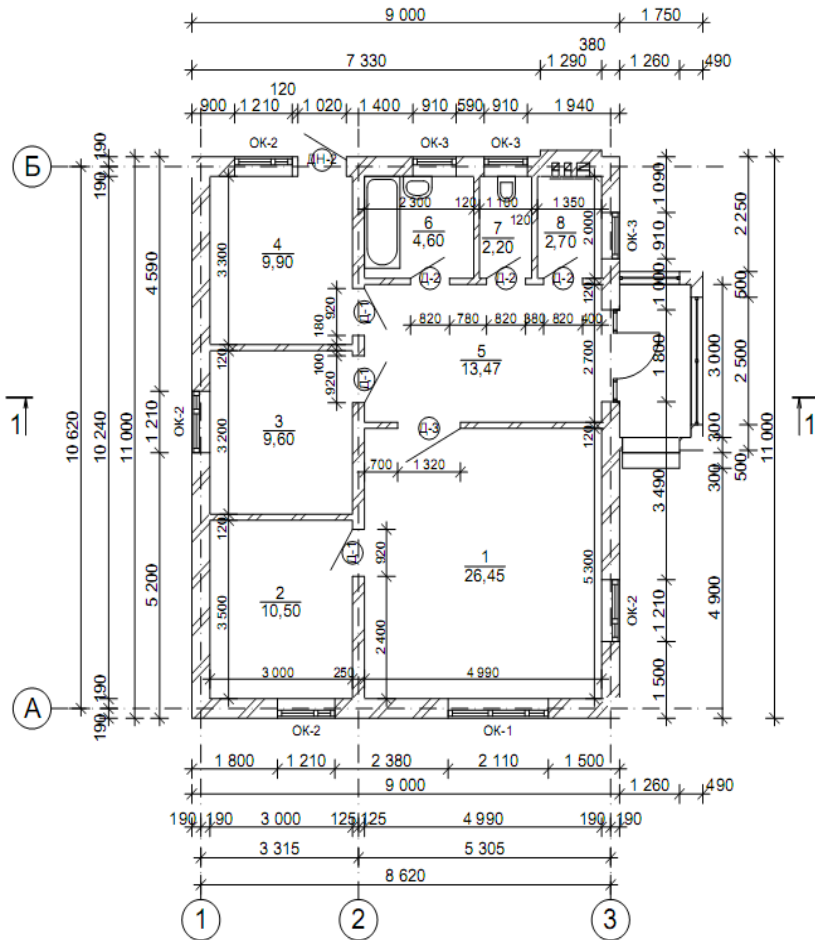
Пример оформления плана первого этажа жилого дома со стенами из мелкогазобетонных элементов
